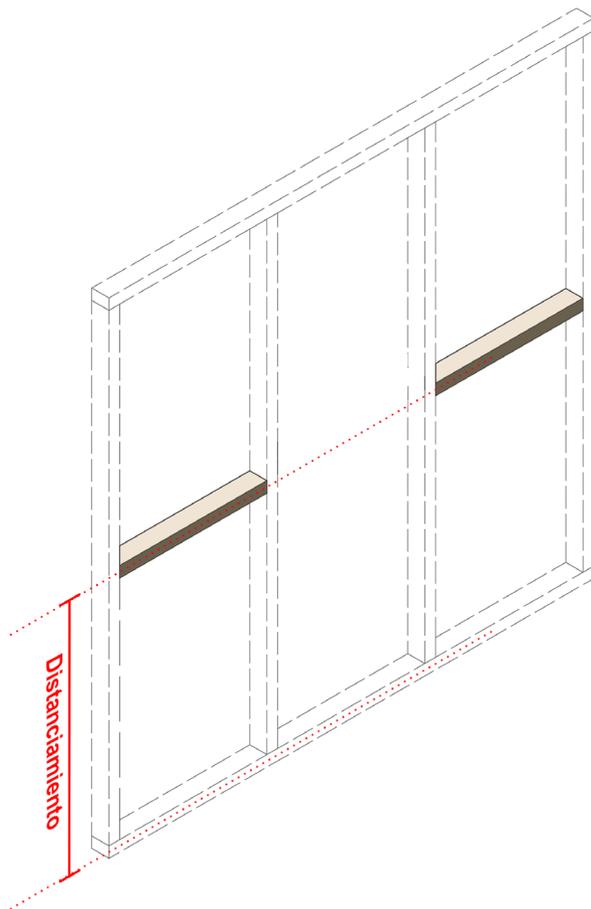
Altura de una cadeneta en un elemento constructivo vertical.
